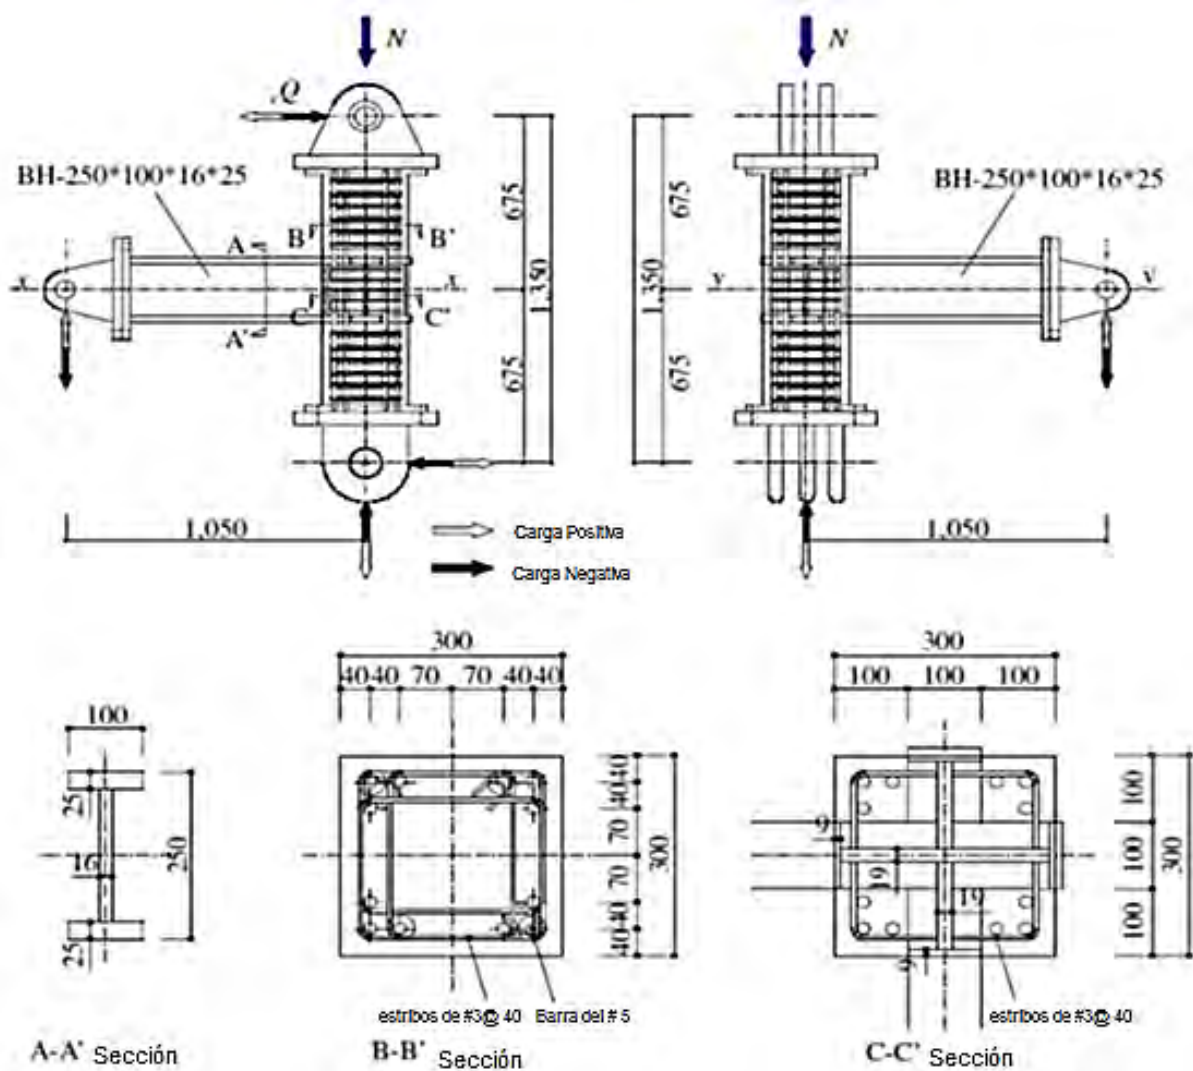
Dimensiones totales del espécimen, secciones transversales y detalles del refuerzo (Baba y Nishimura, 2004).
